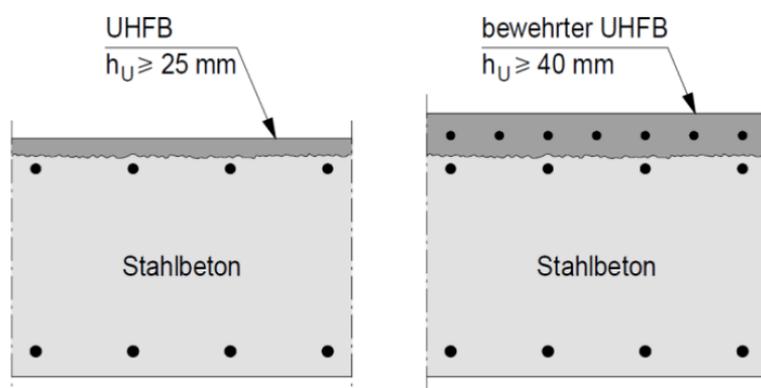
Grundkonfiguration des UHFB-Beton-Verbundbaus, gemäss SIA 2052
